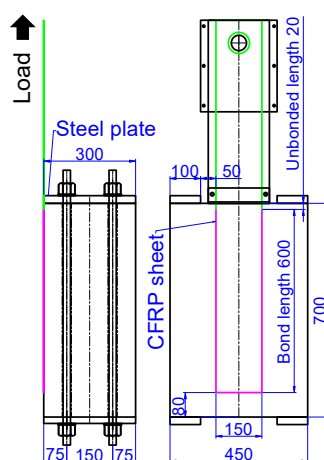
付着試験の供試体寸法 (単位 : mm)
